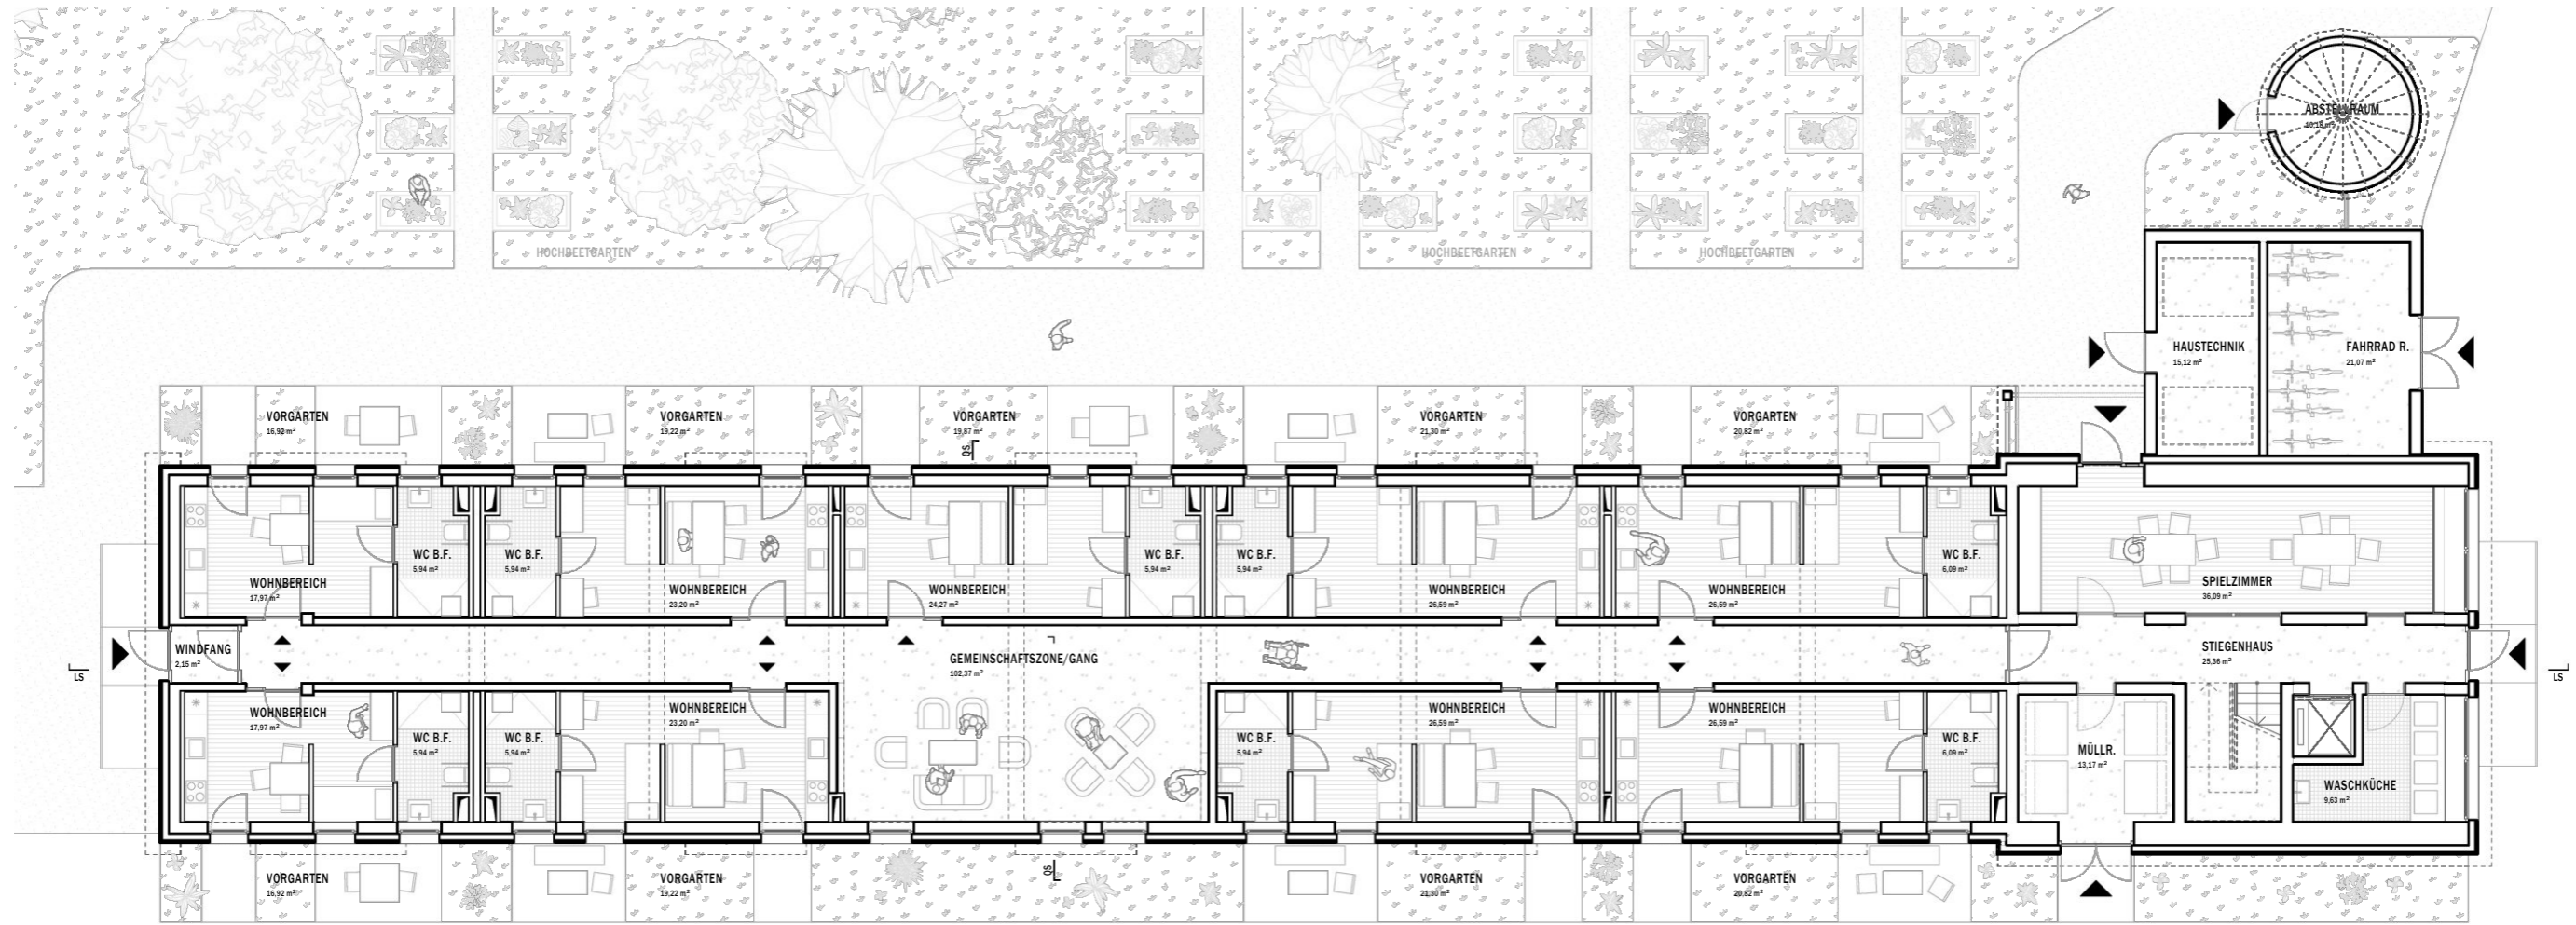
Grundriss EG, Umbau Stallgebäude
